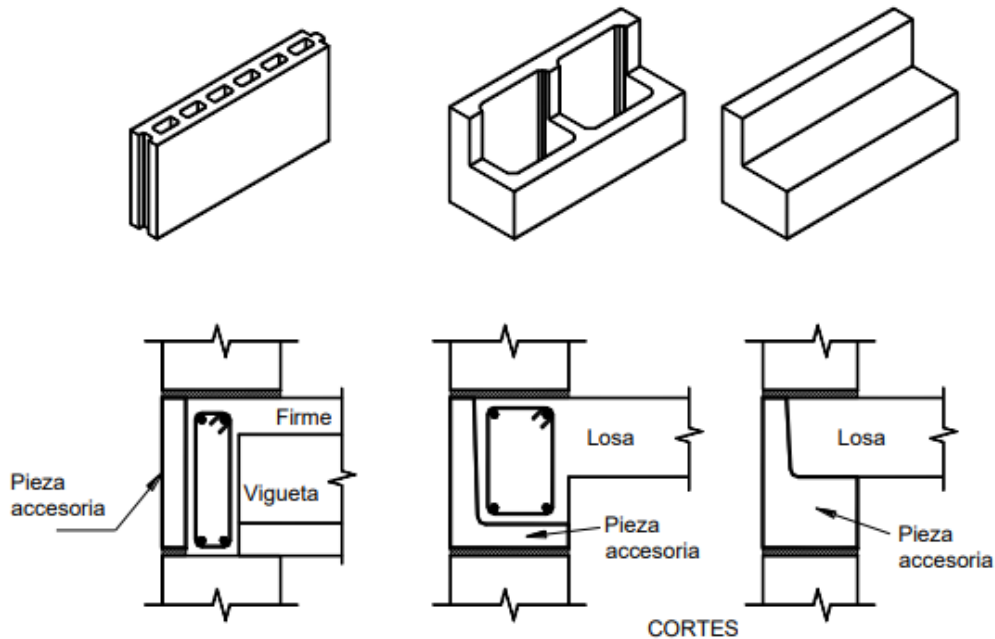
Bloque tipo “U” utilizado en muros de mampostería para dinteles o cadenas
